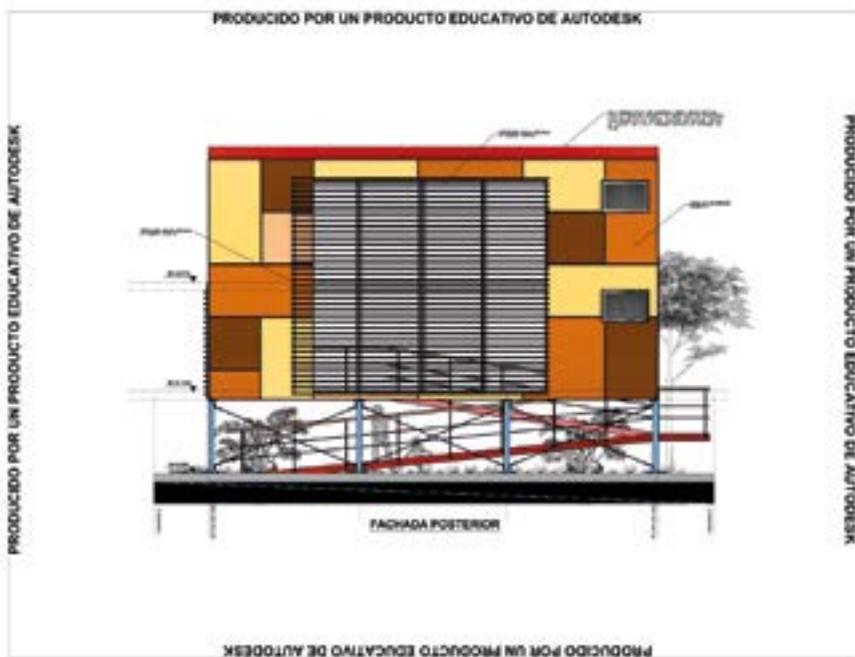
Vivienda palafítica con fachada interior que da vista al patio central.
